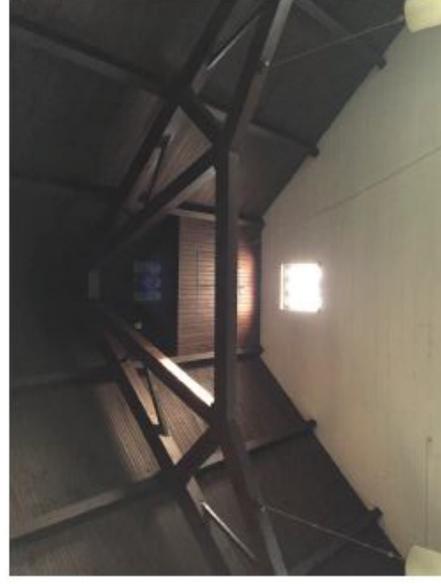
Plâtrage, pannes de bois et structure d'acier
